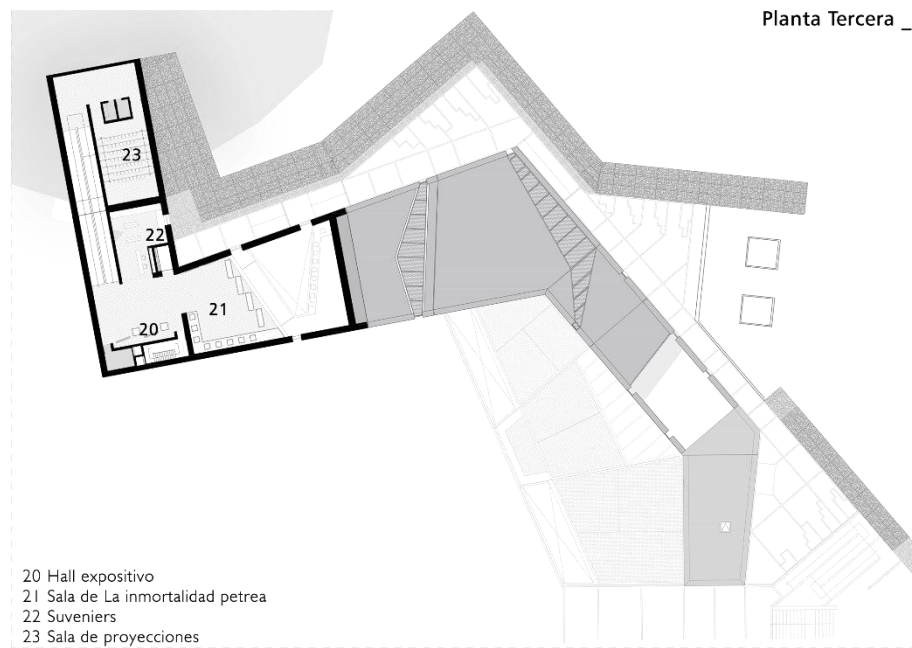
/ Planta tercera. Fuente: Elaboración propia.
